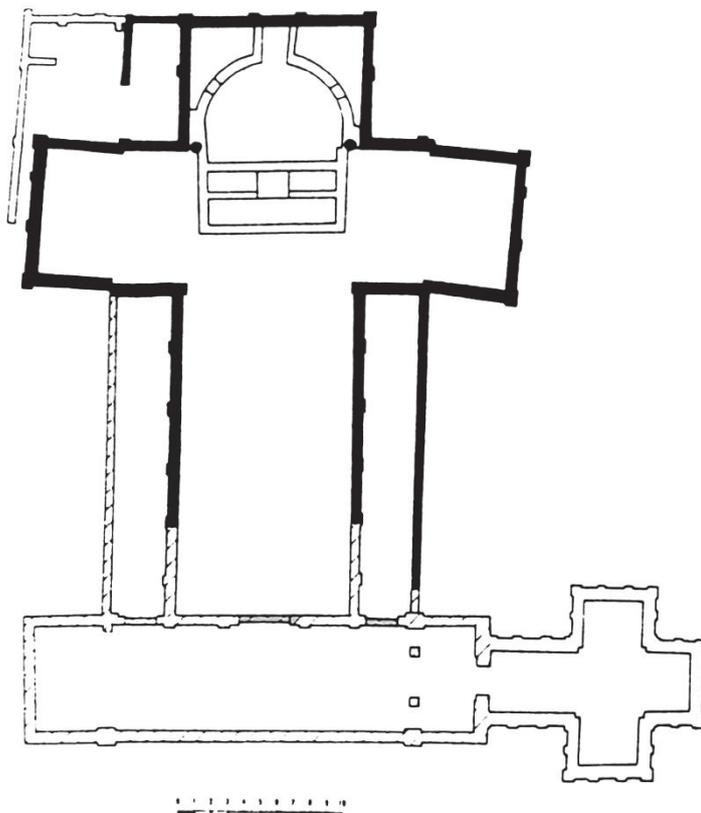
Reconstrucción del plano de Rávena. Fuente: Jäggi 2016.
